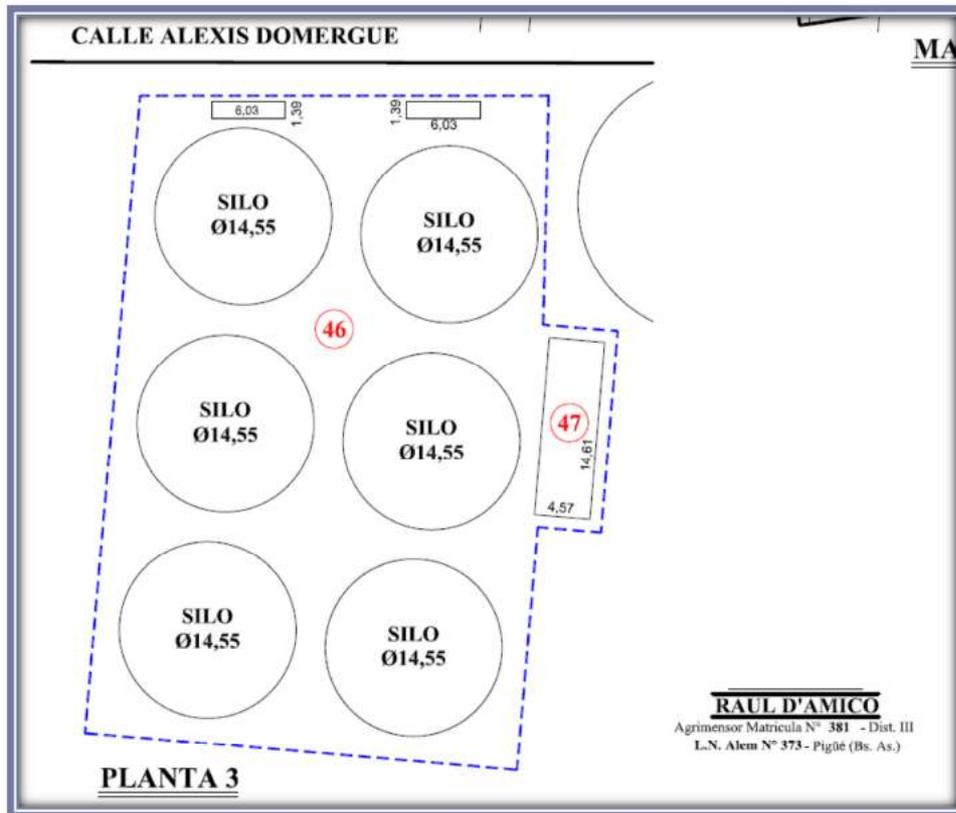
Planta de Silo 3 (Ref. n° 46) y caseta de descarga (Ref. n° 47)
